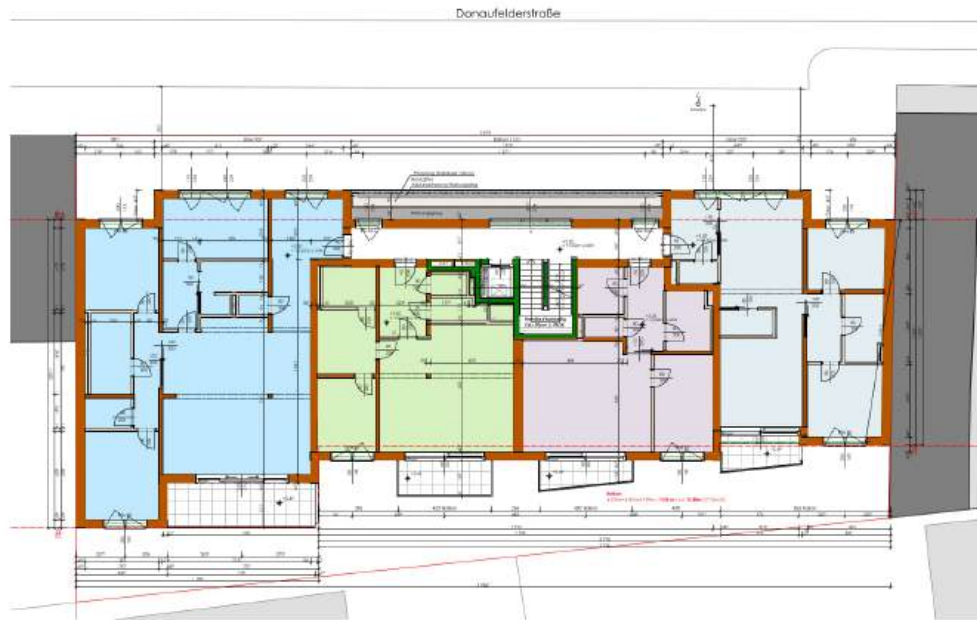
Grundrissdarstellung Regelgeschoß 22. Donaufelder Straße 174-178
